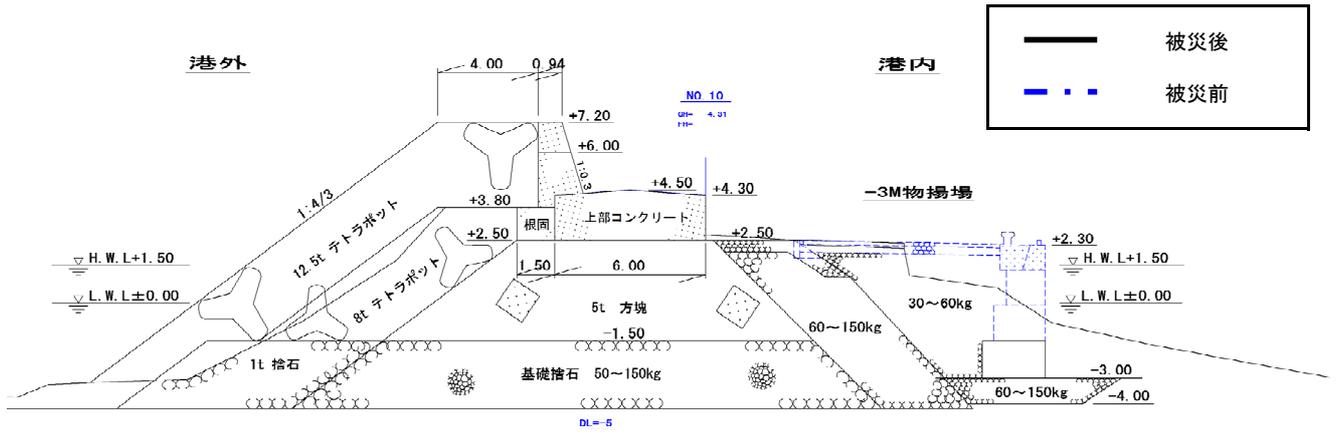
No.25 大洗港区_第1埠頭地区A物揚場 (-3m) の断面図 (被災後)
